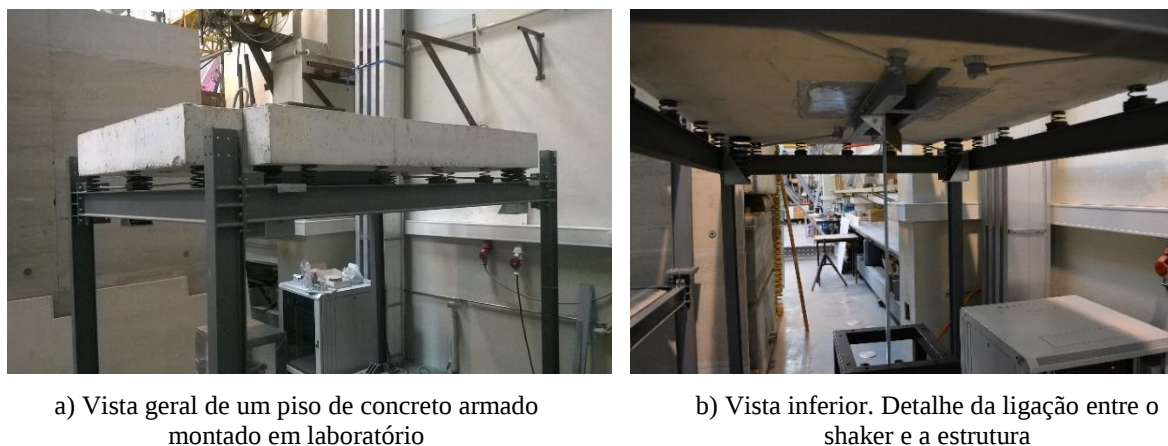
Laje de concreto armado apoiada sobre molas e pórtico metálico
